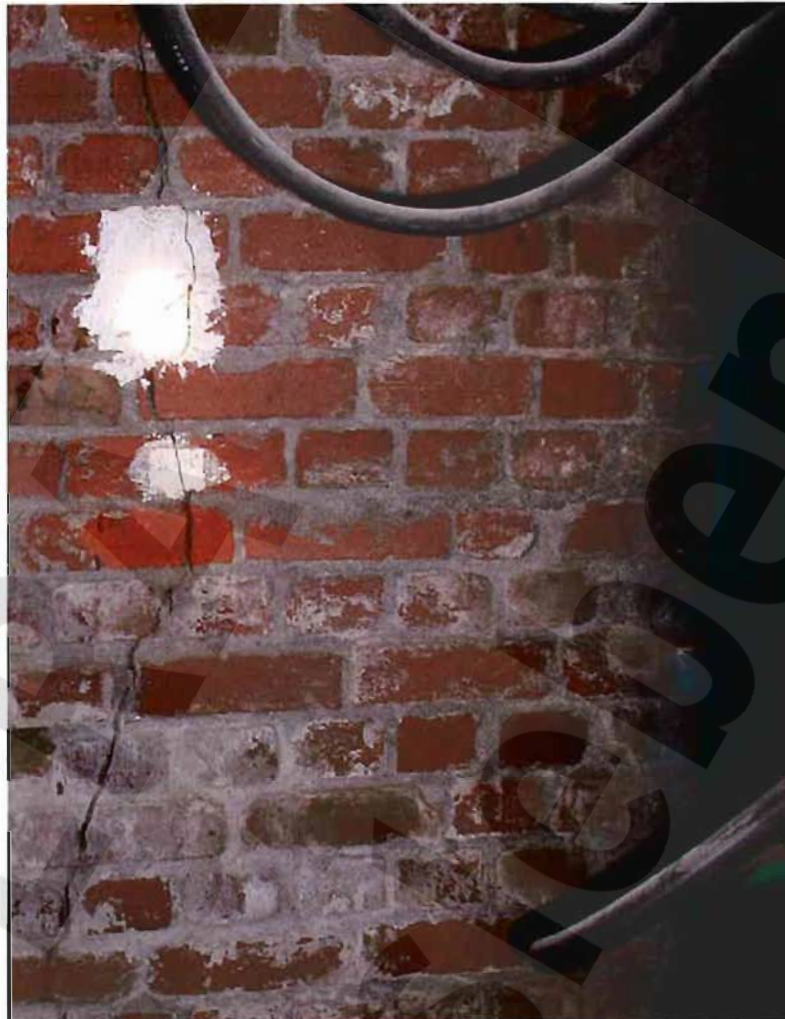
Schacht Bartensleben Füllortkeller -372 mNN Sohle -SE- vertikaler Riss im Mauerwerk
